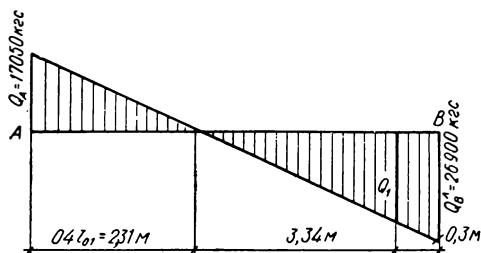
Эпюра поперечных сил в первом пролете ригеля.
